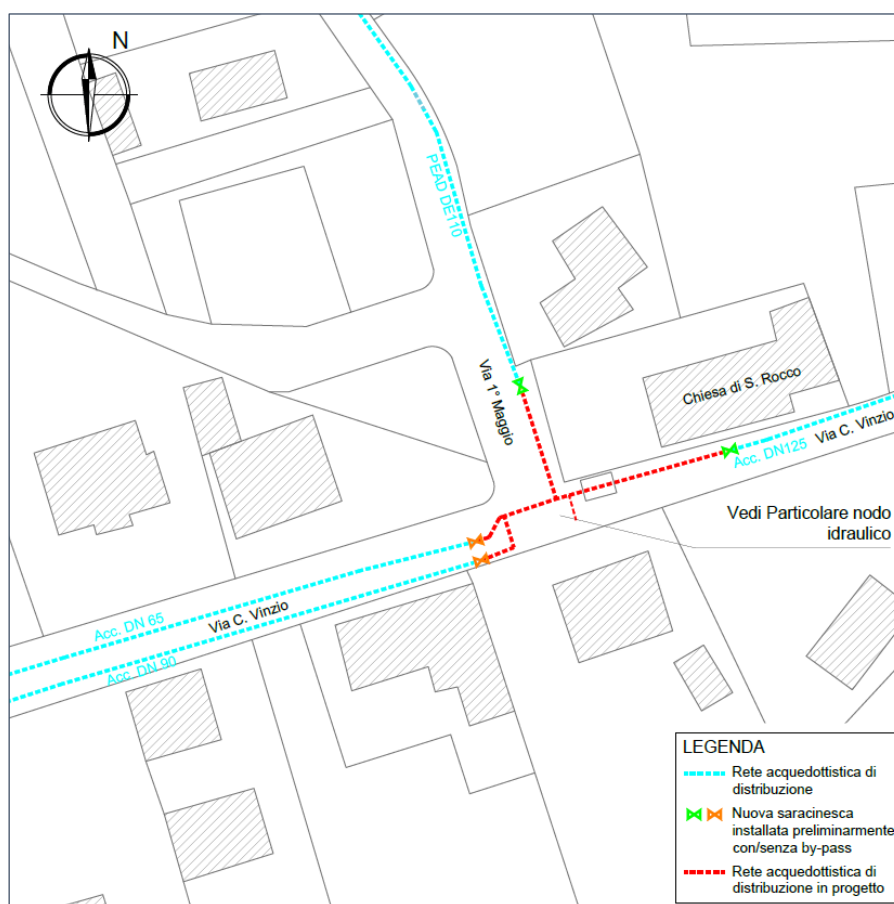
Rifacimento pozzetto incrocio Via I Maggio – Via Vinzio: planimetria di progetto
